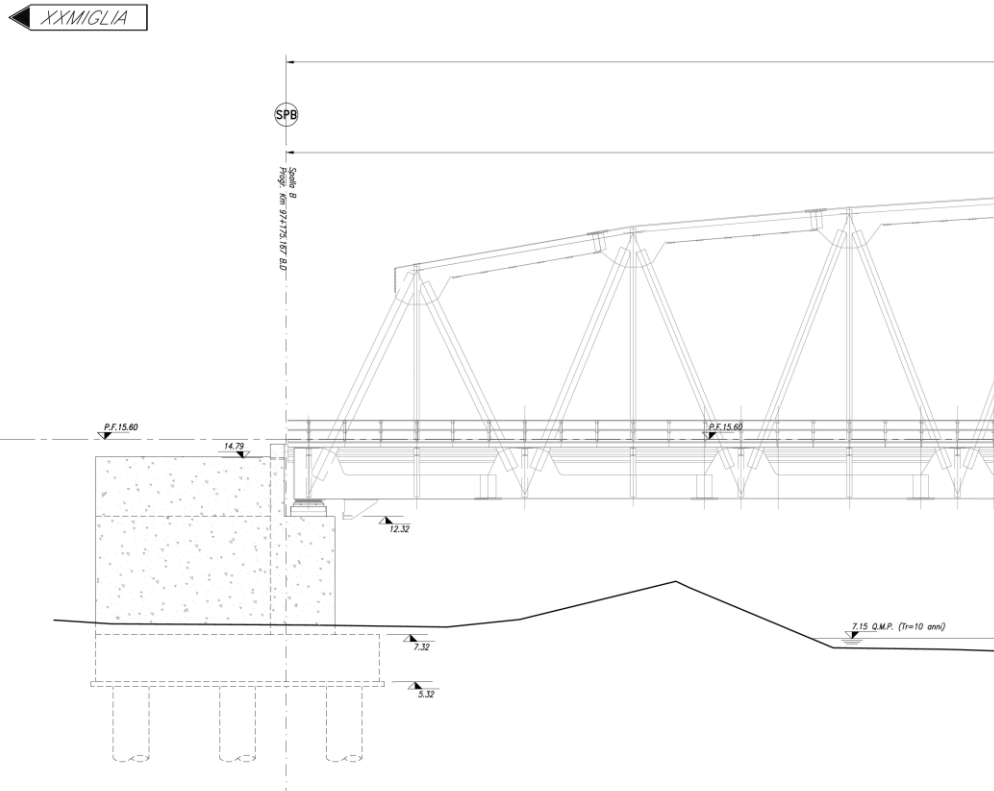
Prospetto longitudinale della Spalla B del viadotto VI08
